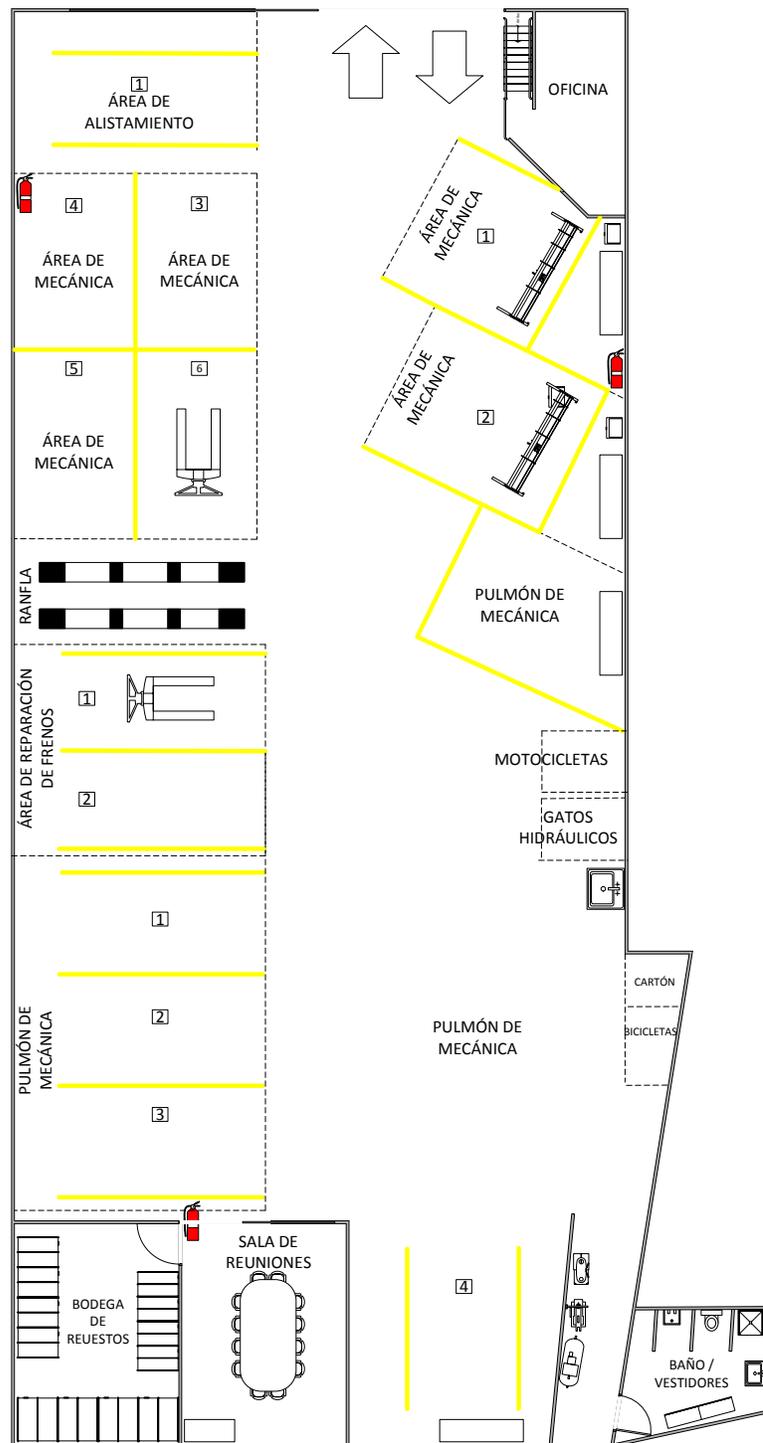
Distribución de planta SAVE CÍA. LTDA.
